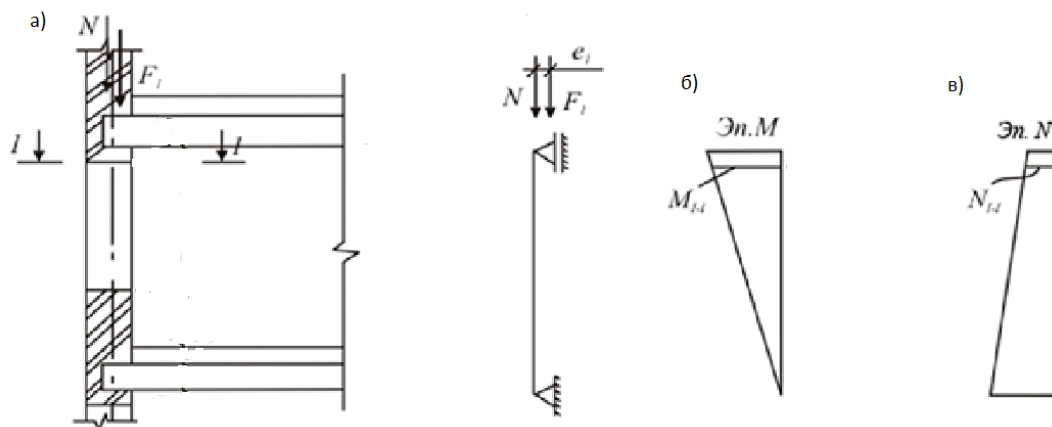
К расчету простенка 1-го этажа: а - конструктивная схема, б – расчетная схема и эпюра изгибающих моментов; в – эпюра продольных сил.
